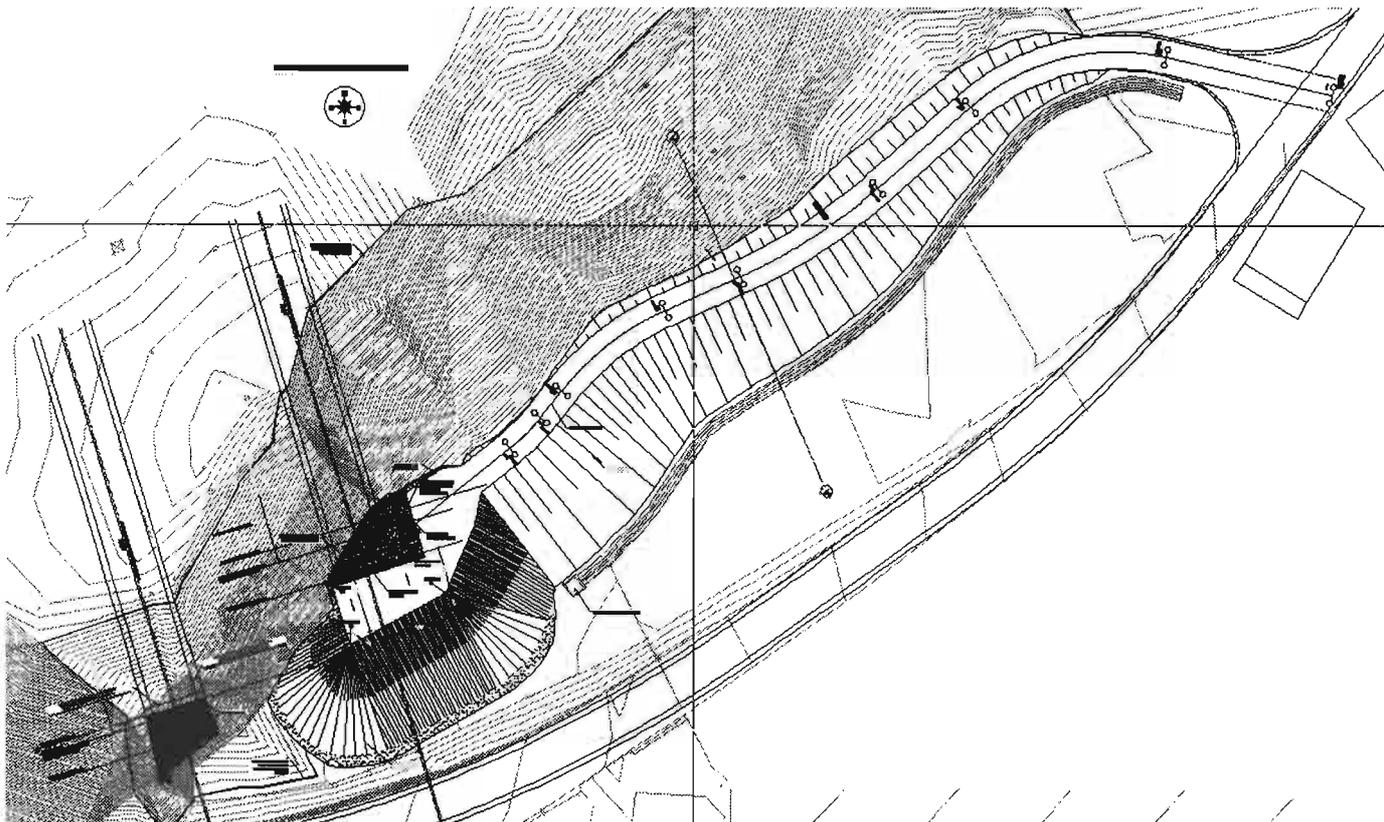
Schema planimetrico Cantierizzazione Scaleres Sud
